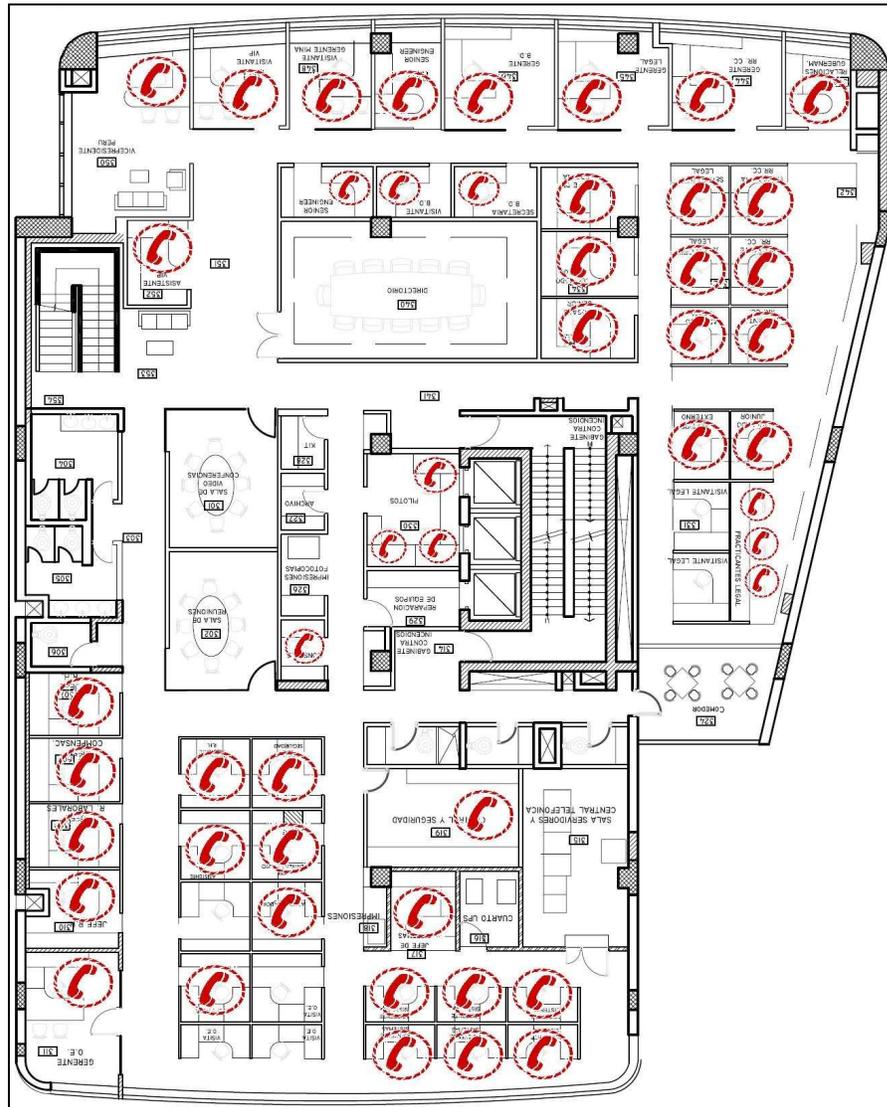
PLANO DE PLANTA FUTURA SA - SEGUNDO PISO
